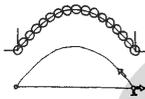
Konstruksi Rangka Batang Bambu
